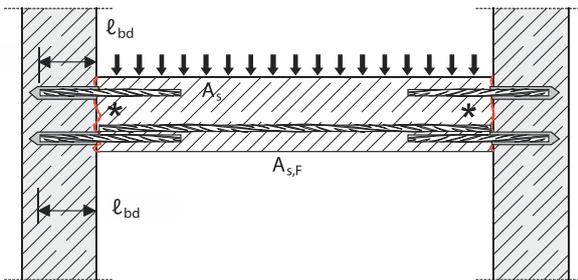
Ancrage direct d'armatures pour élément principalement en compression. Les armatures subissent une contrainte en compression.
